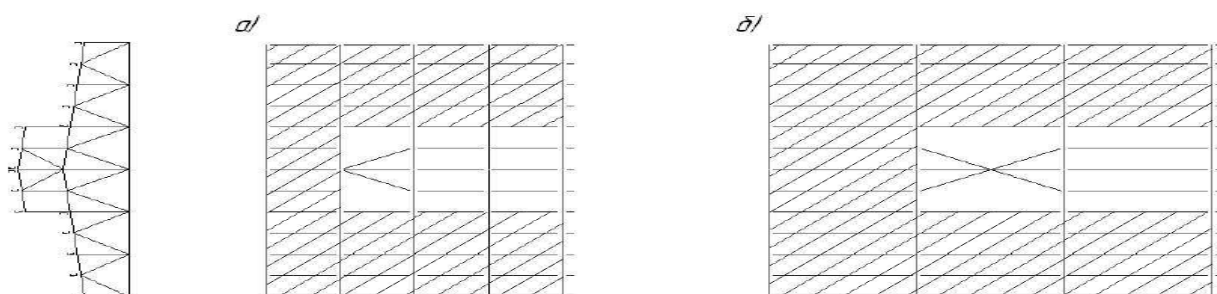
Обеспечение устойчивости верхних поясов ферм под фонарями в покрытиях, где функции связей выполняет стальной настил: а) шаг ферм 6 м; б) шаг ферм 12 м.
